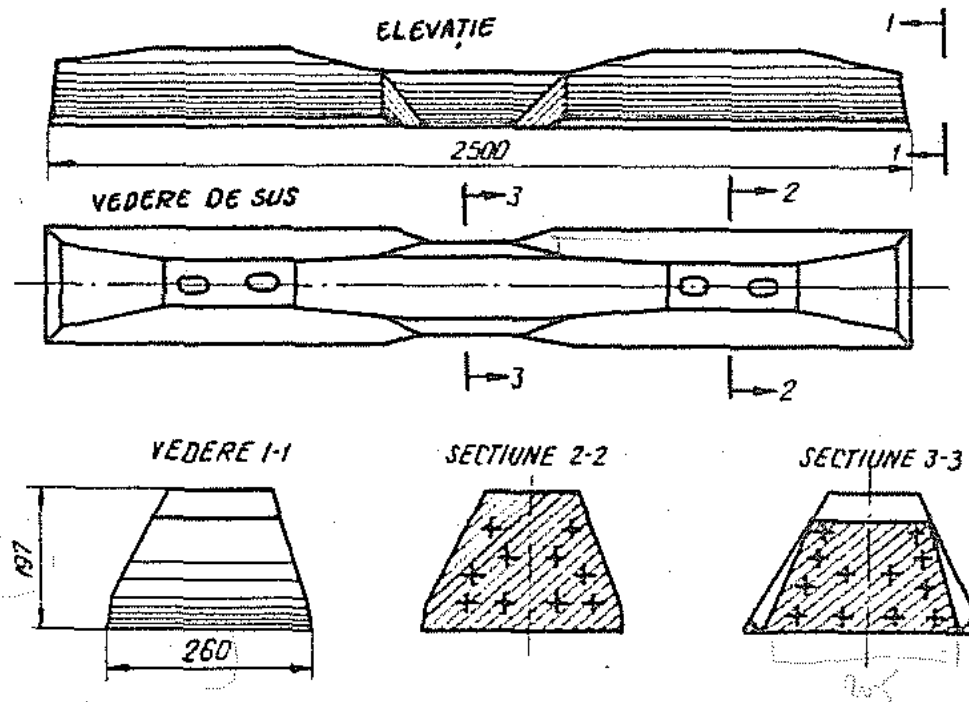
Traversa de beton armat precomprimat forma T_6
